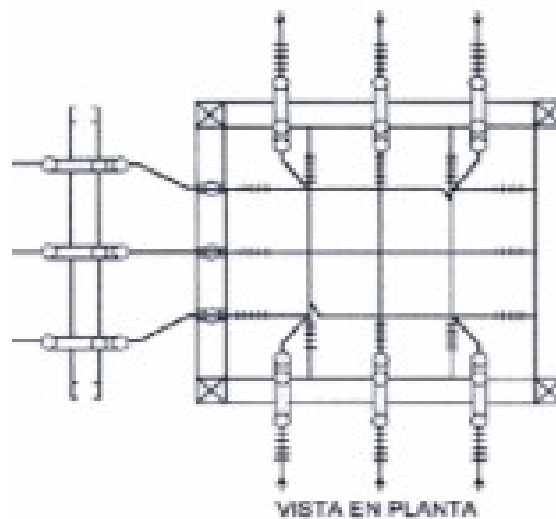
Vista en planta de subestación eléctrica tipo intemperie
